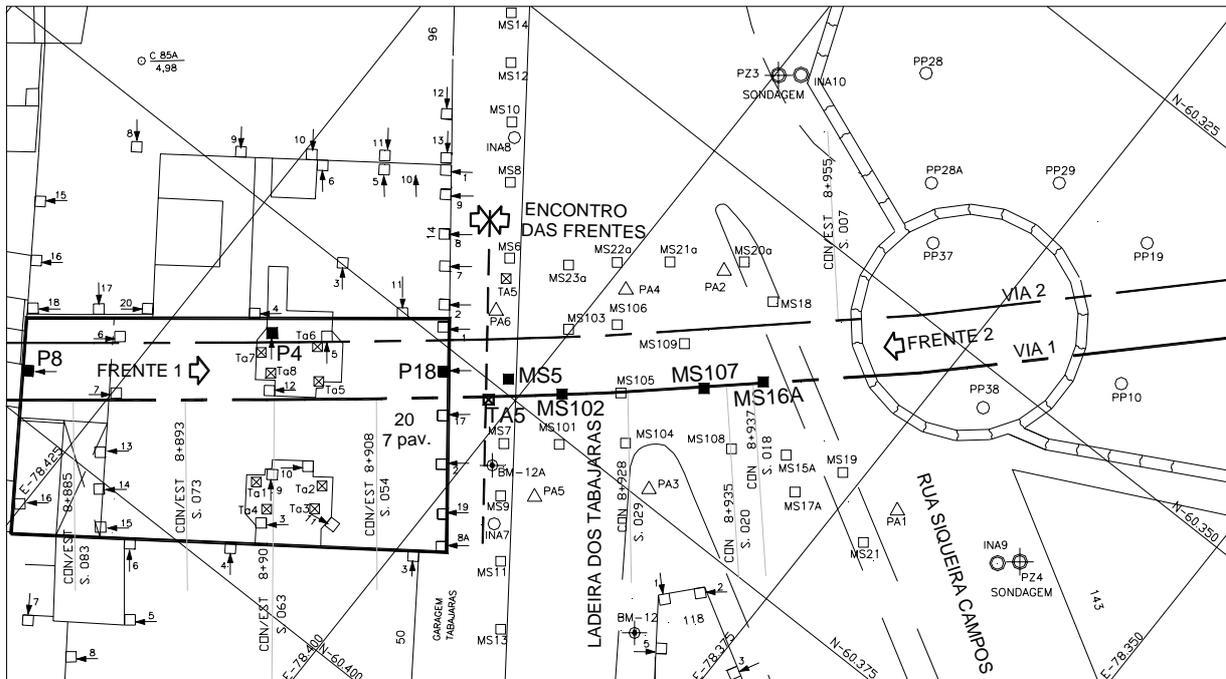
Planta da instrumentação na região do encontro das frentes 1, 2.
